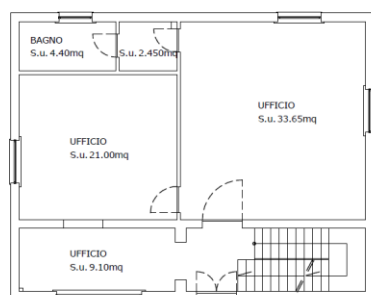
Planimetria palazzina ad uso ufficio (fuori scala)
